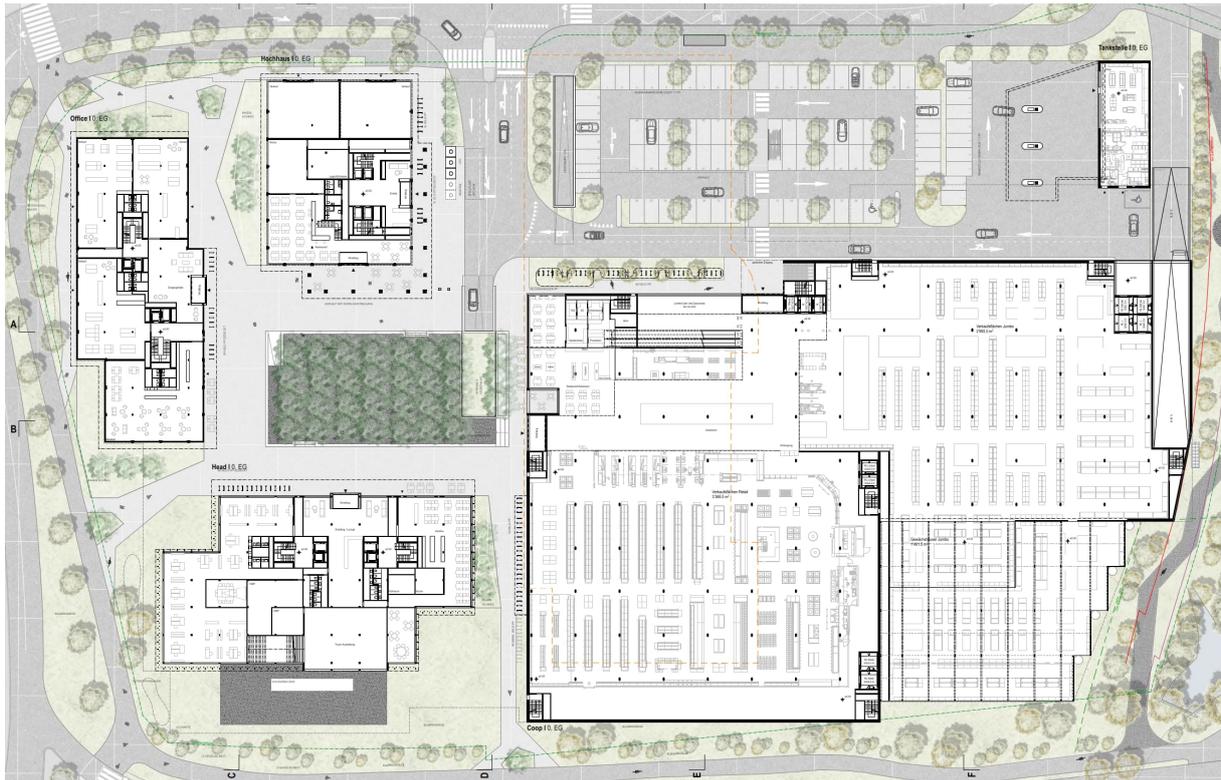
Richtprojekt Architektur, Plan Erdgeschoss, Bauten von links nach rechts: Office, Head, Hochhaus, Coop, Tankstelle (CST Architekten, 2023)
